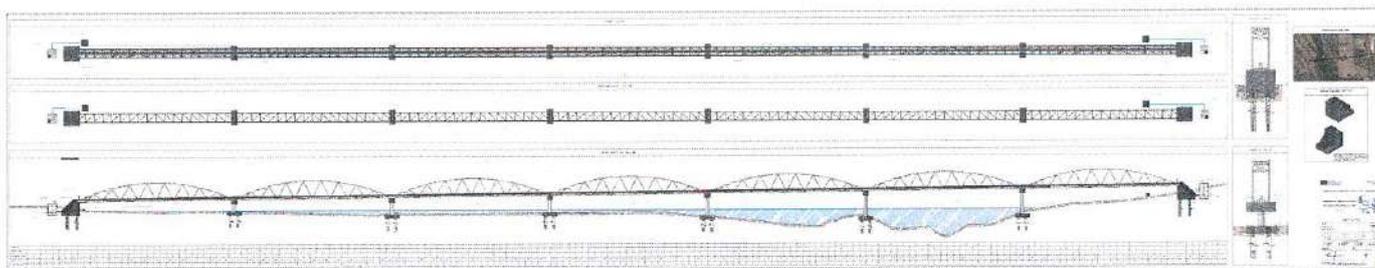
Elaborato di progetto "Ponte Belice" pianta , profilo e sezione attraversamento fiume Belice.
